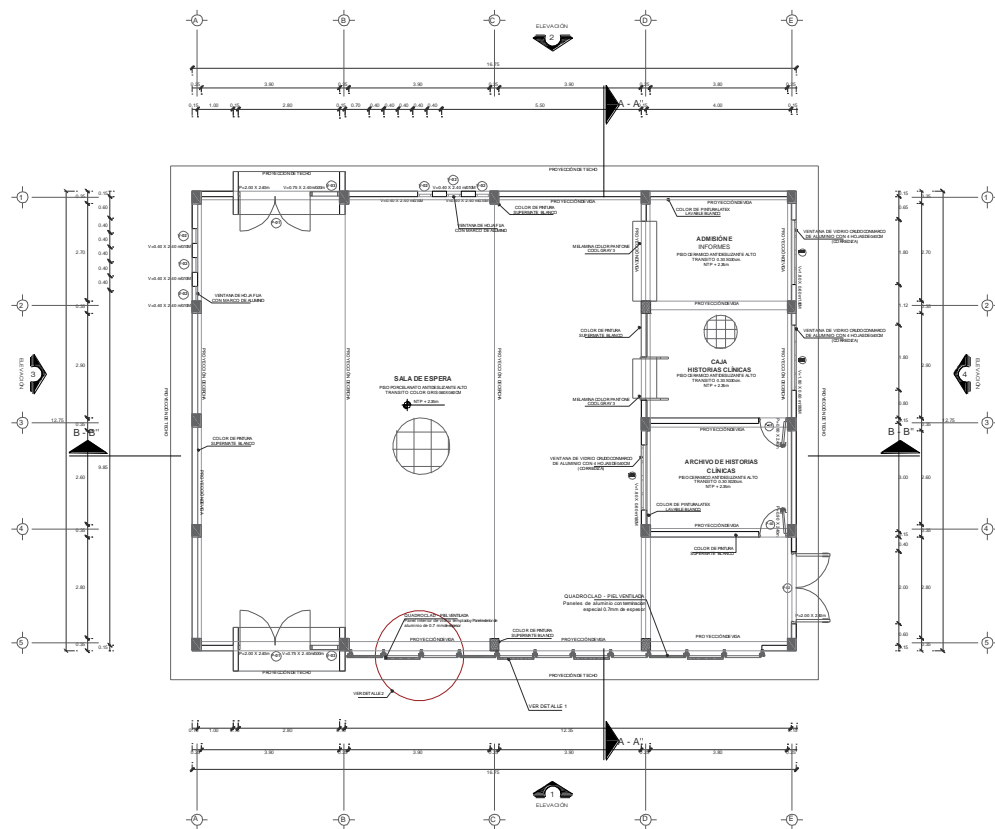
Planta proyecto - Zona de Admisión - Bloque 01. Elaboración propia.
